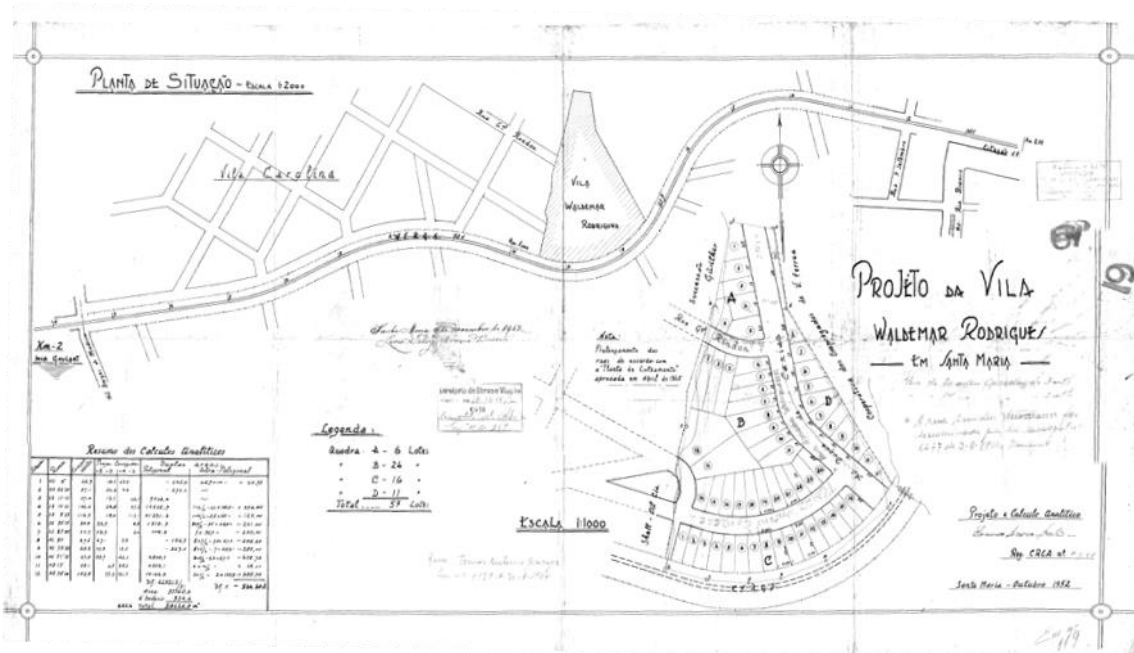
Planta do Projeto e Cálculo Analítico realizado por Bezerra em 1953.
